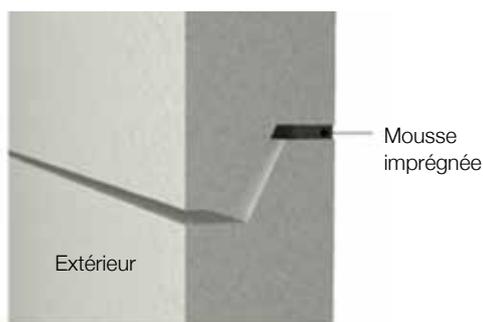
Principe de pose de mousse imprégnée en coupe verticale sur joint horizontal de panneaux préfabriqués
